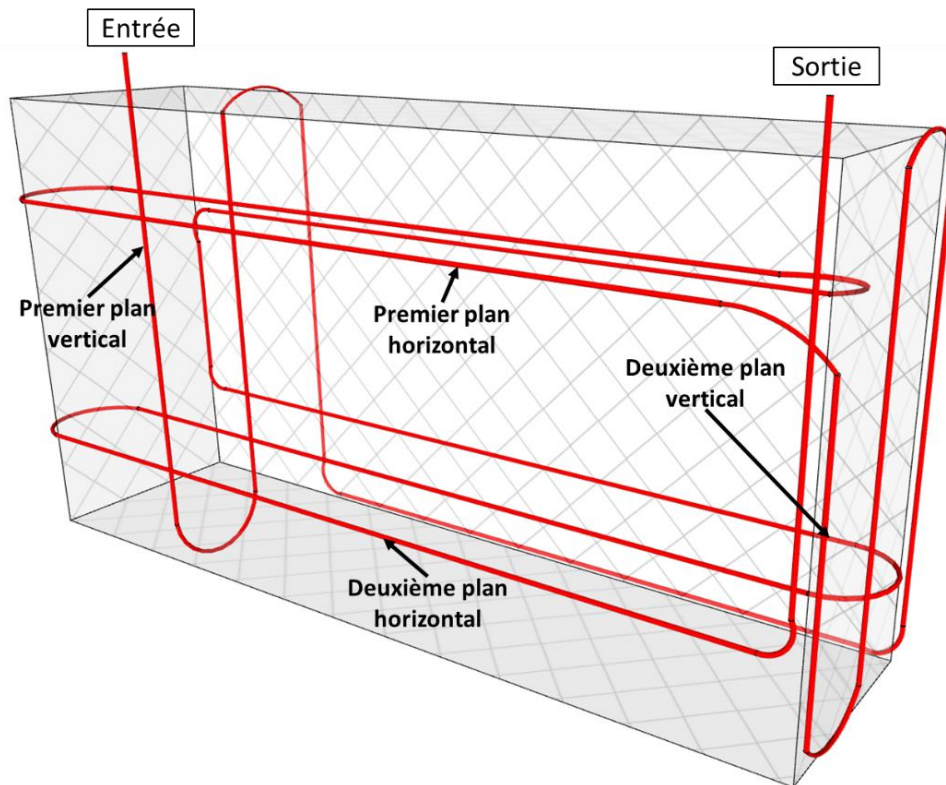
Plan d'instrumentation d'un bloc armé par capteur à FO noyé dans le béton.
